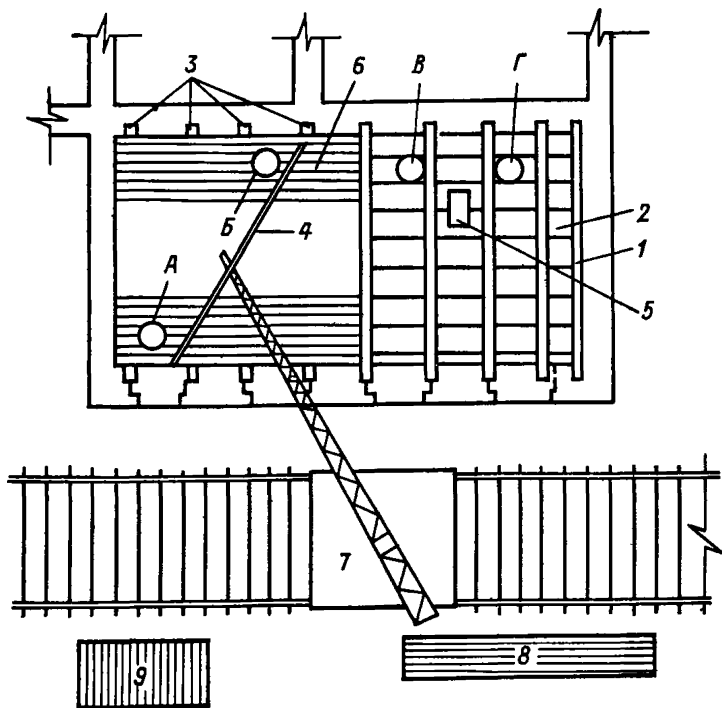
Схема организации работ на захватке по монтажу перекрытия из железобетонных тавровых балок с плитами заполнения
